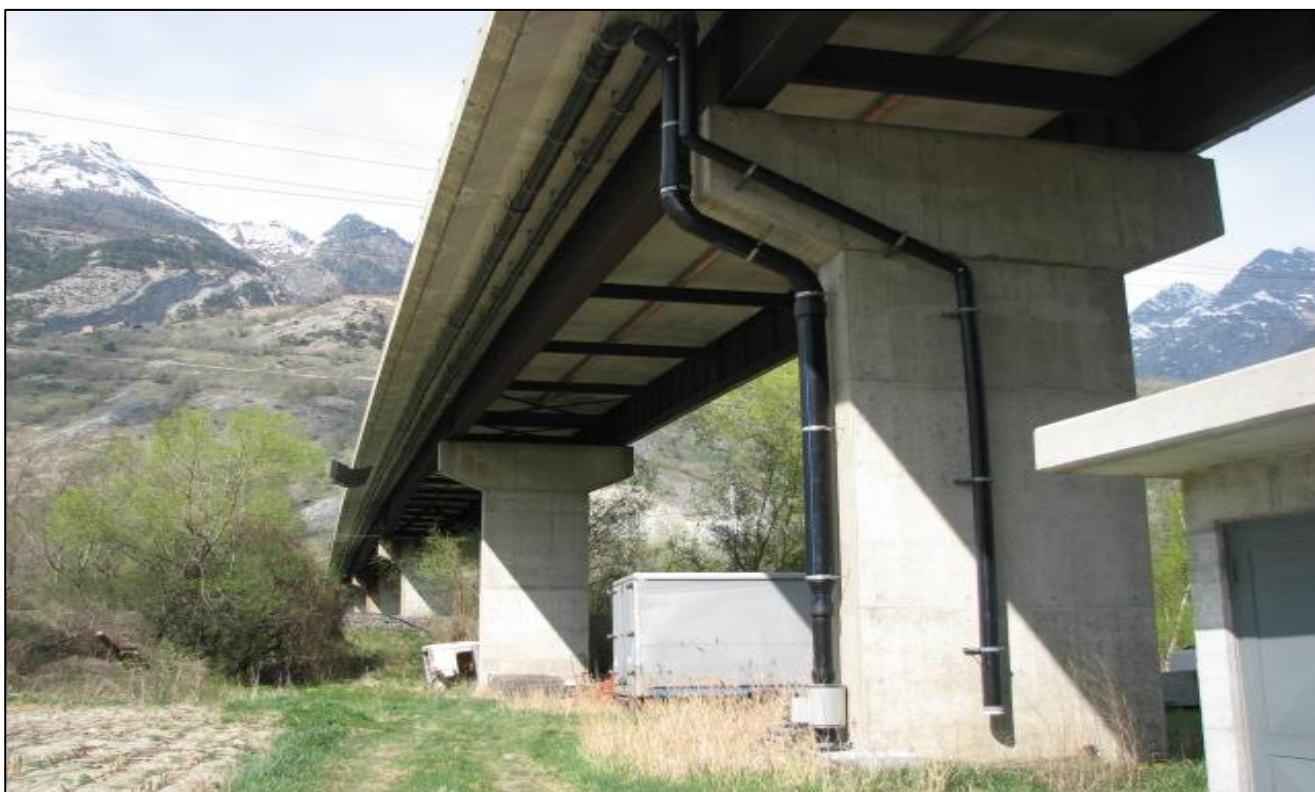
Brückenuntersicht mit Werkleitungen best. Brückenpfeiler P4
